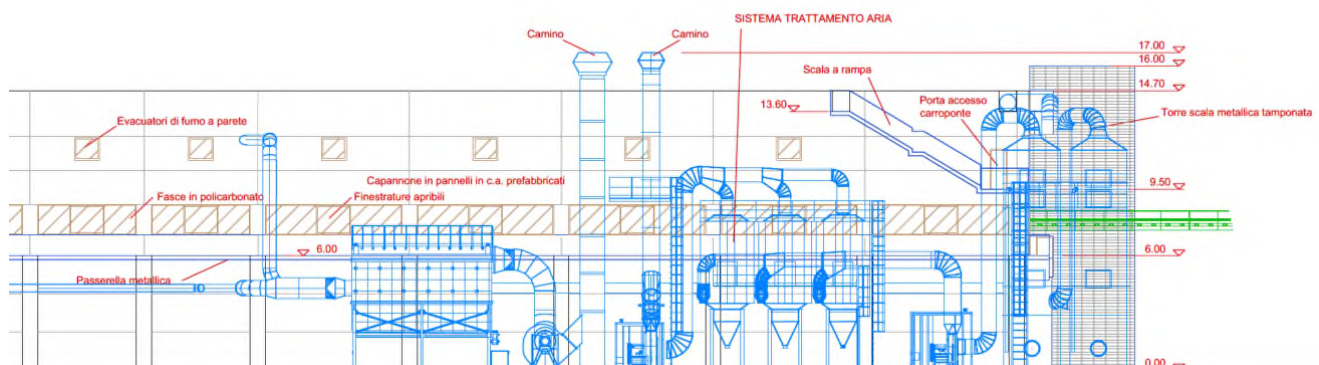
Sistema di abbattimento aria presentato con Modifica Non Sostanziale dell'AIA – Impianto SRA - Prospetti
